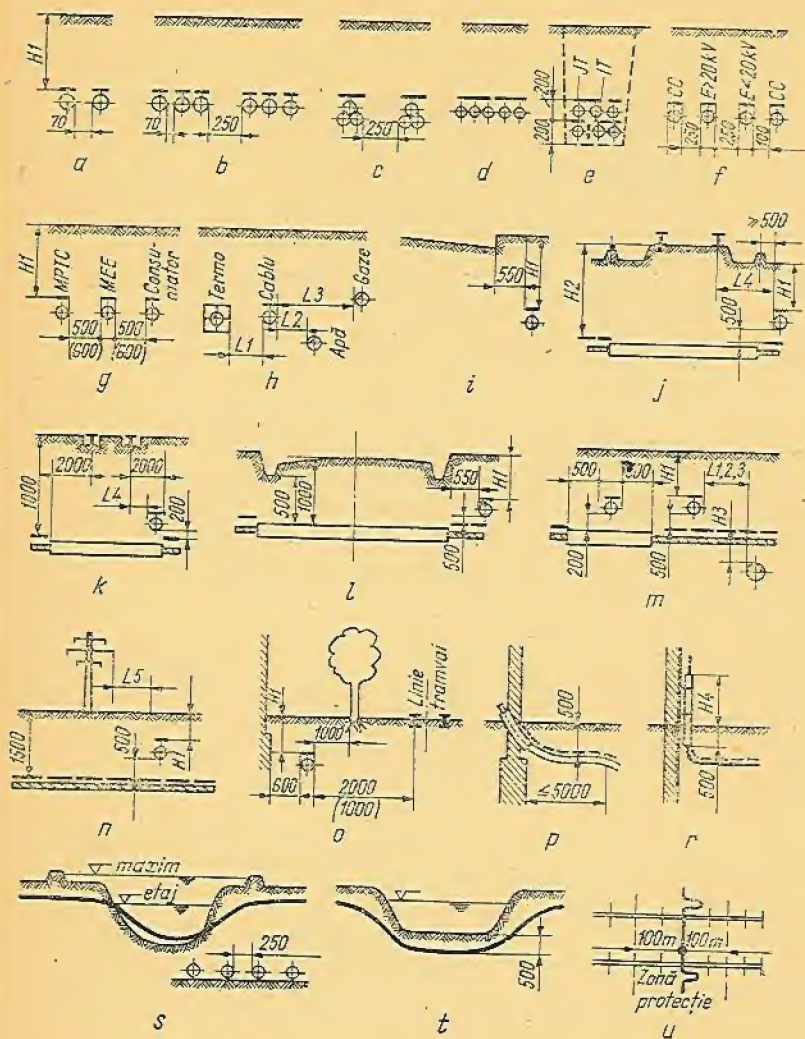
Distanțe minime la pozarea cablurilor în pământ.
